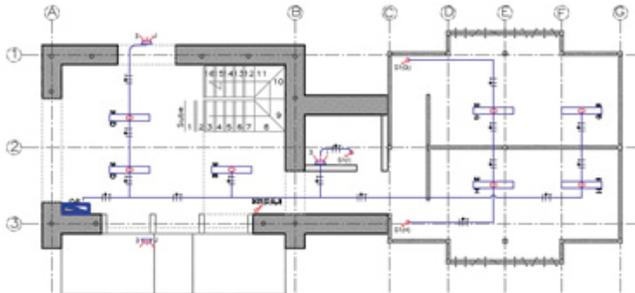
Planta de iluminación red eléctrica vivienda modular sostenible (modelo 2D)
